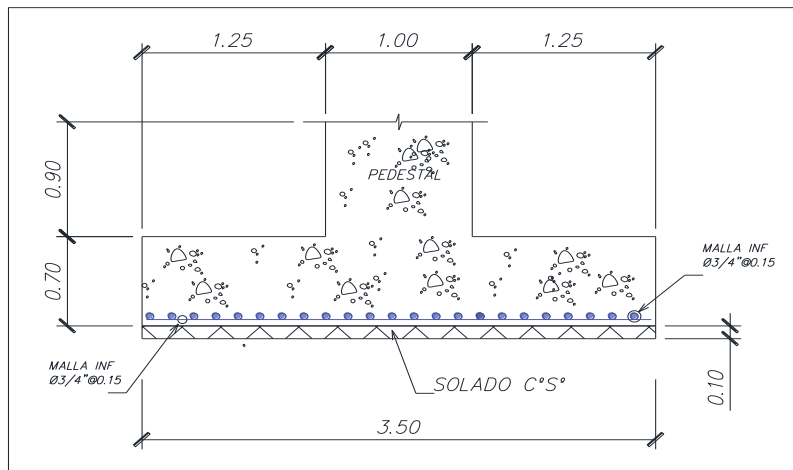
Corte transversal de zapata aislada. (Fuente Propia).
